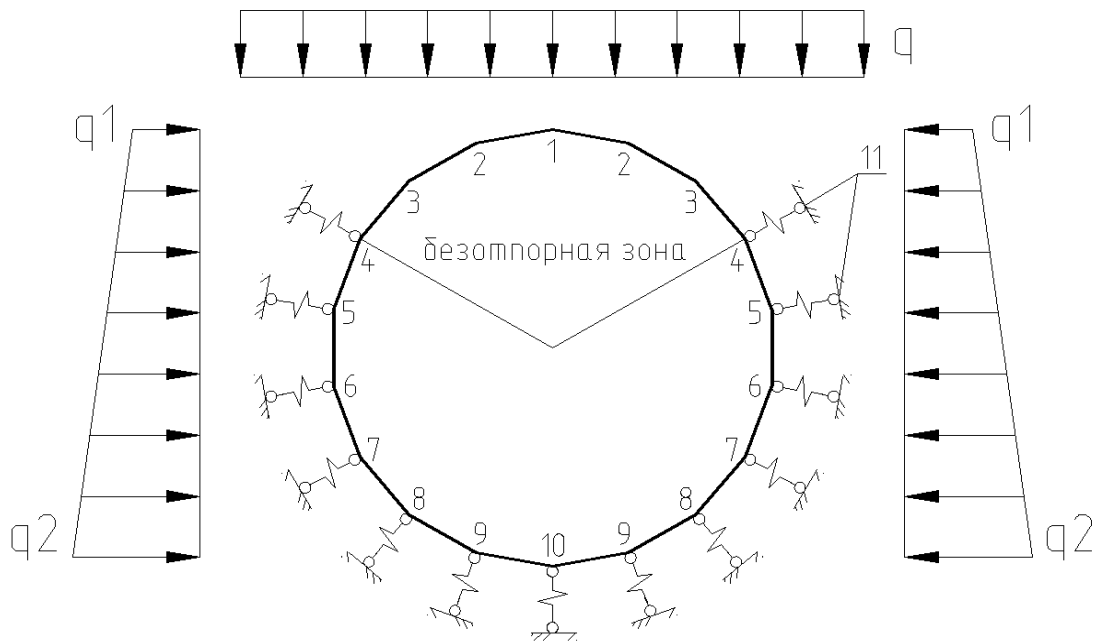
Расчетная схема круговых оболочек (обделок) по методу «Метропроекта» (q —вертикальная нагрузка в уровне шельги, q_1 , q_2 —горизонтальные нагрузки от грунта, 1-10 – расчетные узловые точки оболочки (обделки), 11 – упруго-податливые опоры).
